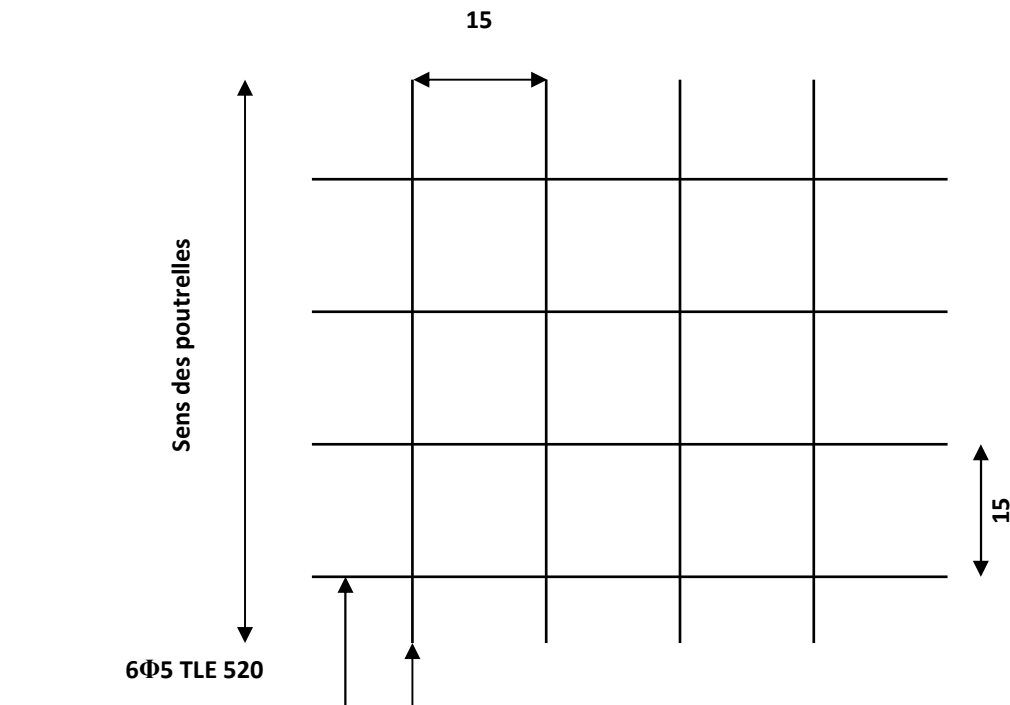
Ferrailage de la dalle de compression avec un treillis soudé 15x15cm
